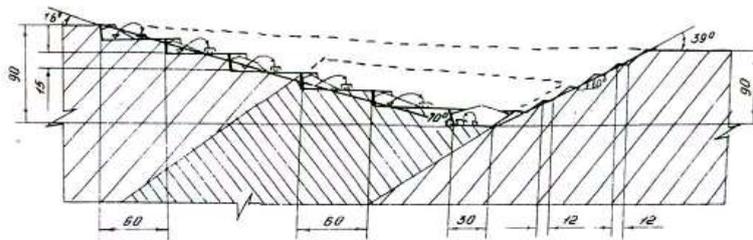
Схема конструкции рабочего и нерабочего бортов карьера
